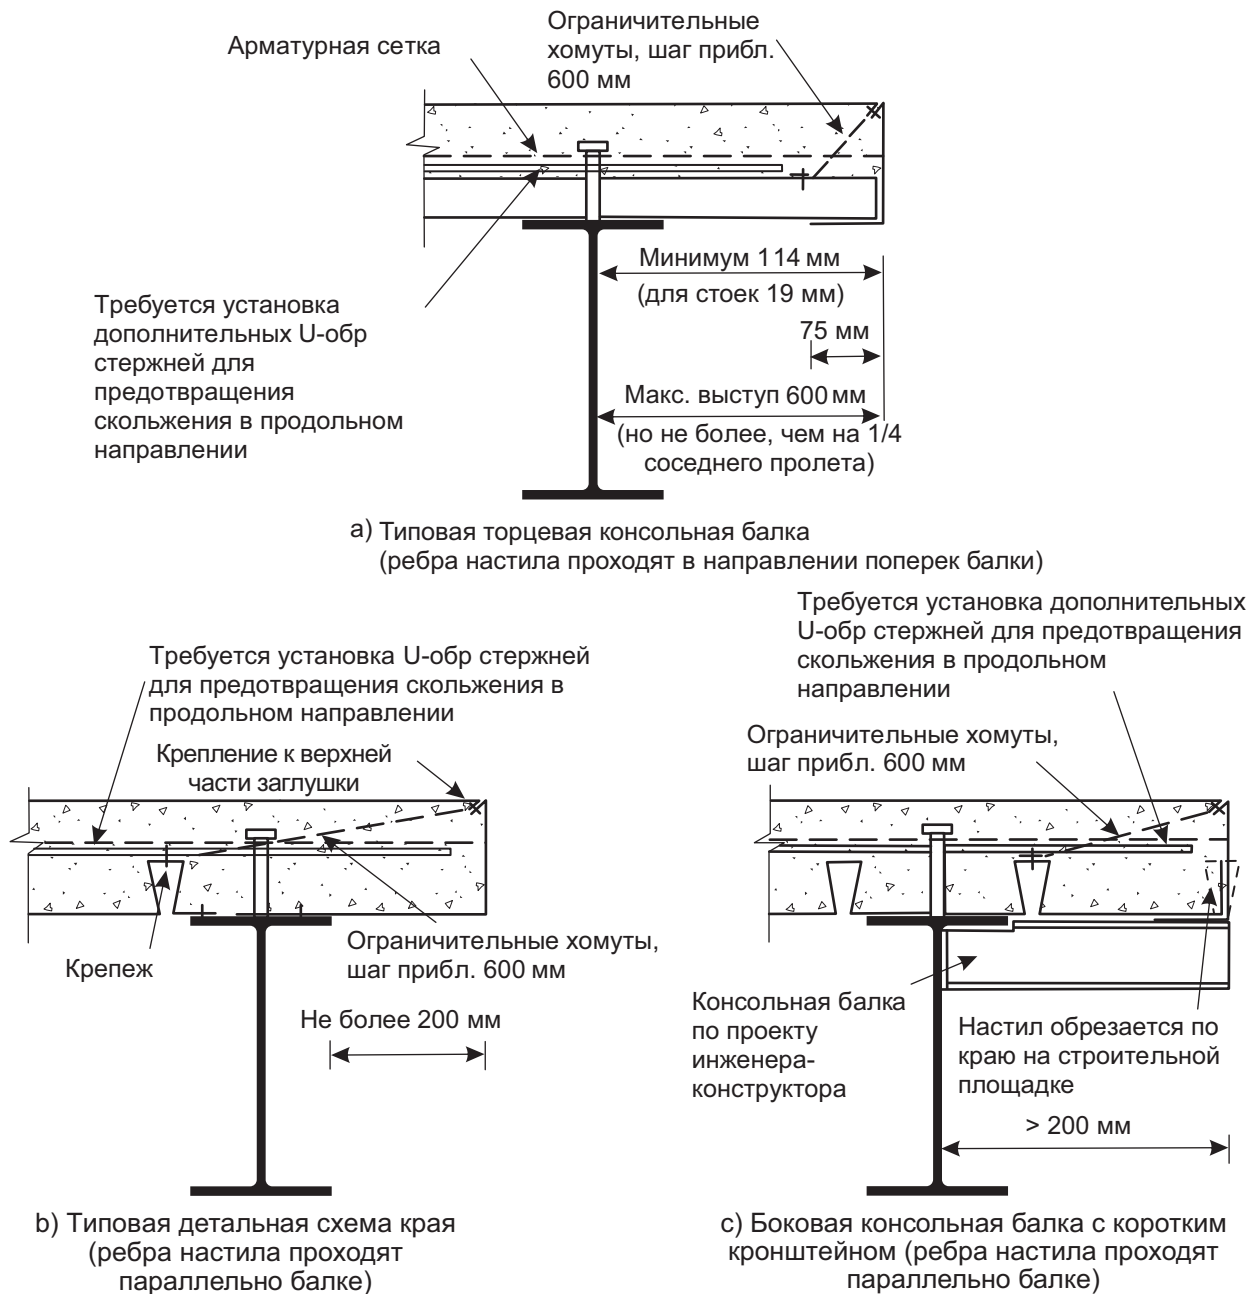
Примеры узлов конструирования крайних участков перекрытия
